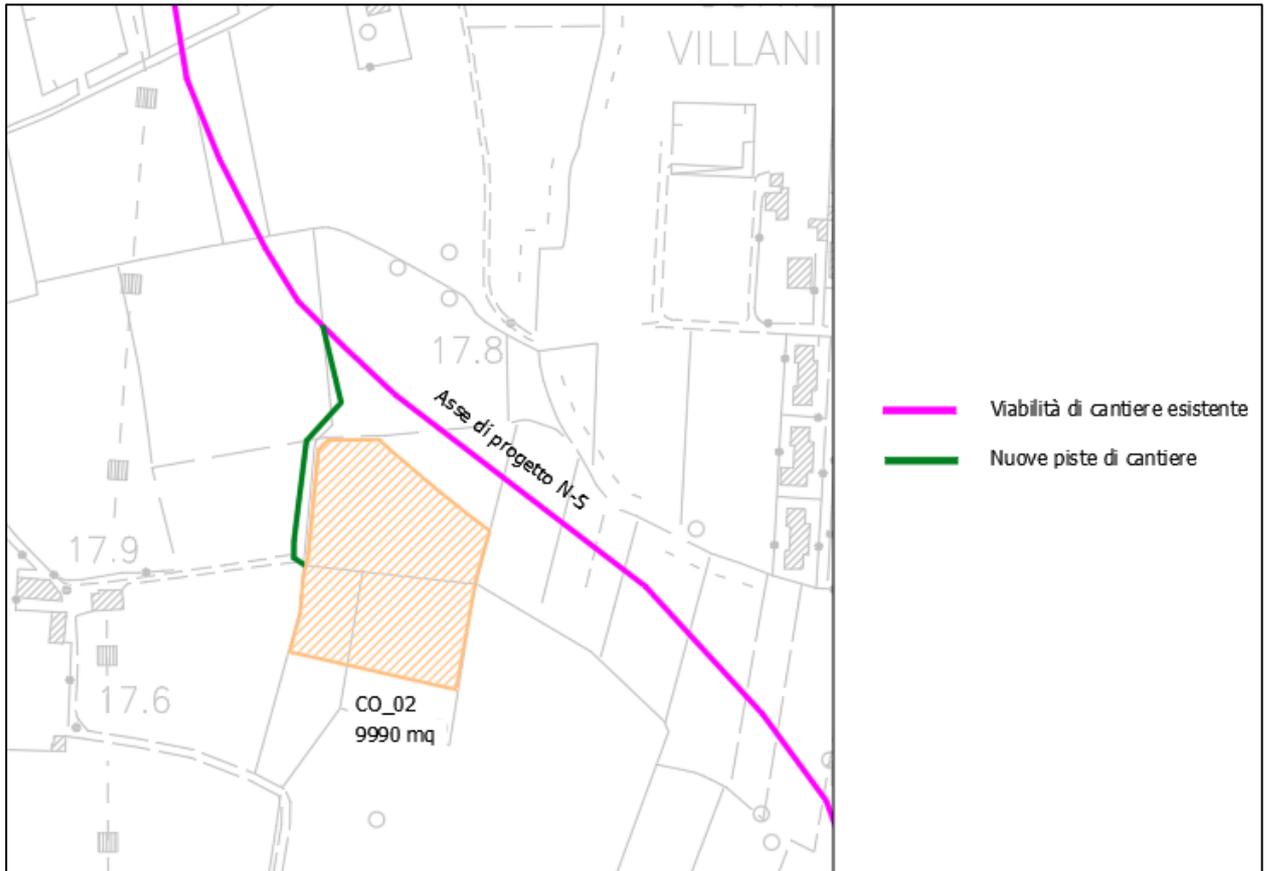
Collegamento tra l'asse N-S e il cantiere operativo CO_02
